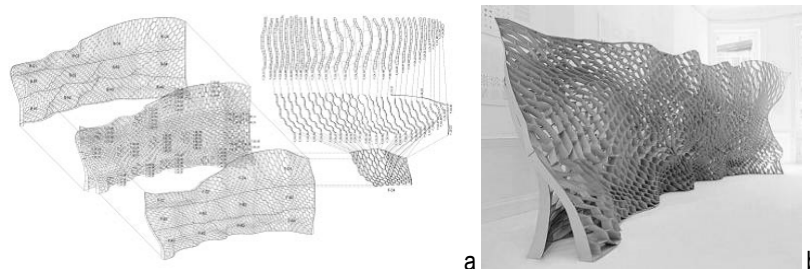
a) Projeto de estrutura complexa utilizando modelos computacionais. Fonte: Architectural Design, 2006; b) Estrutura montada, após corte de peças de madeira realizado por máquinas de precisão. Fonte: Architectural Design, 2006.
